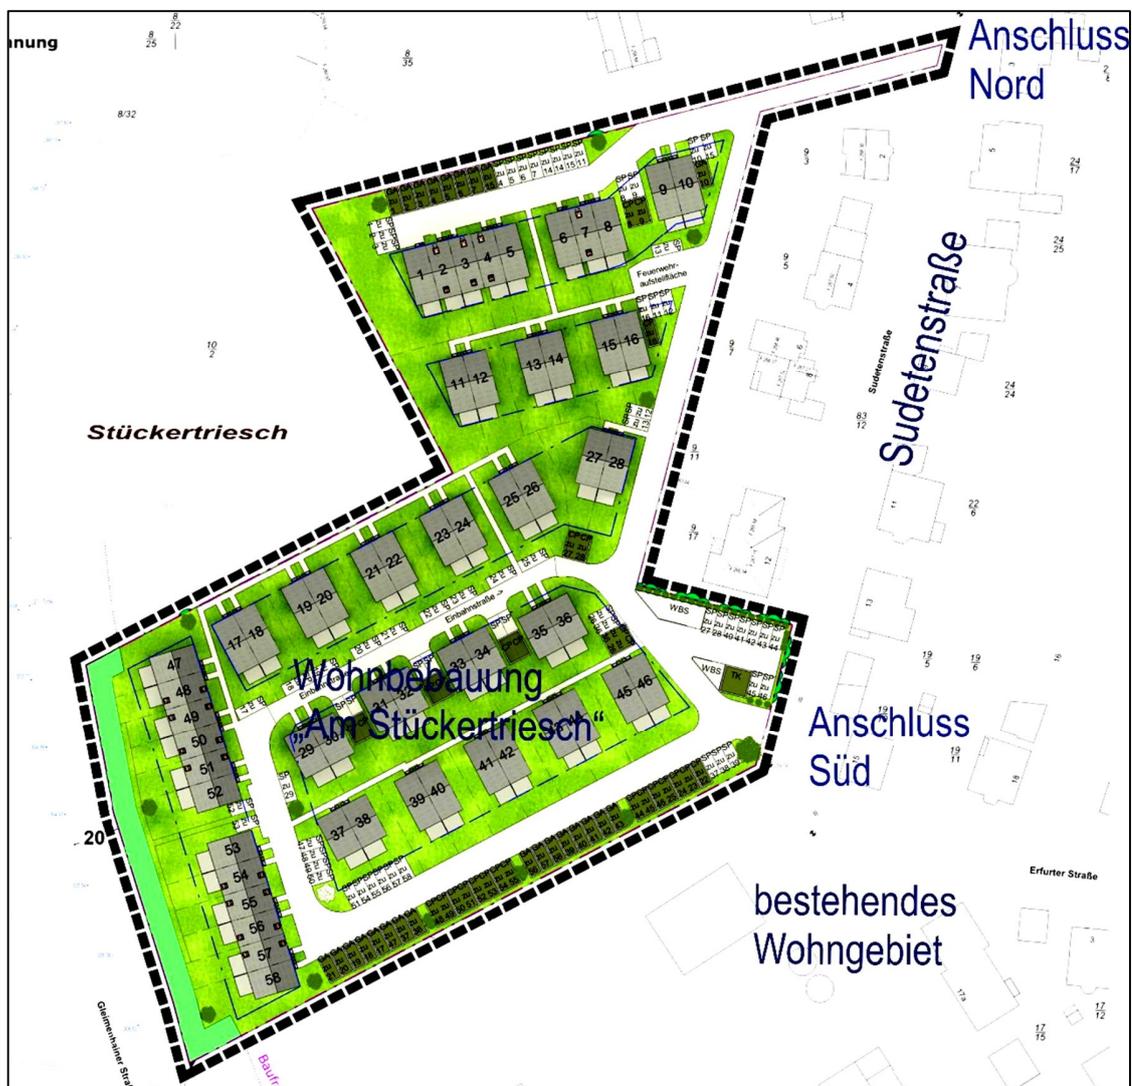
Vorschlag für den Bebauungsplan „Am Stückertriesch“ der Werner Wohnbau GmbH Co. KG vom 30. April 2021, blaue Beschriftungen ergänzt
